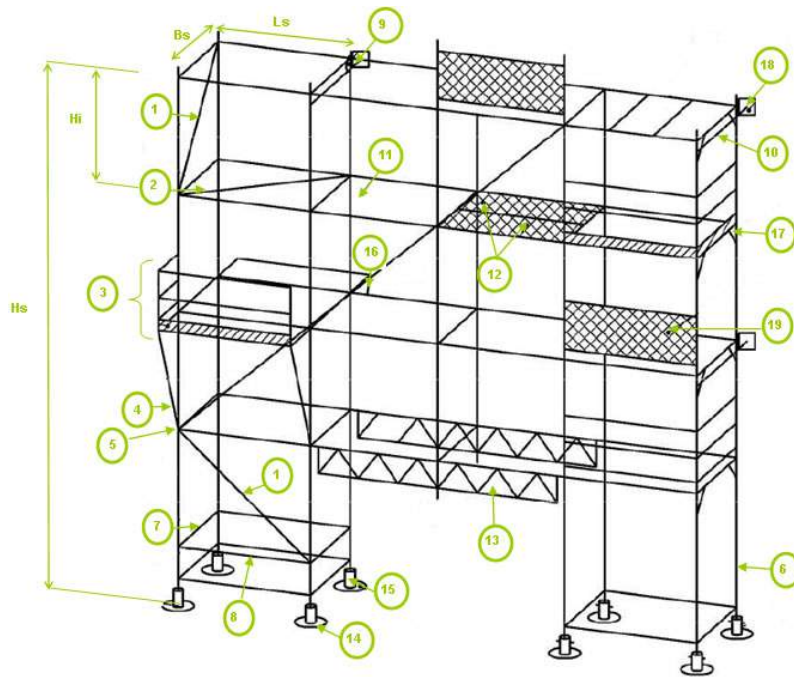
Andamio tubular de fachada. (UNE-EN 12811-1)
